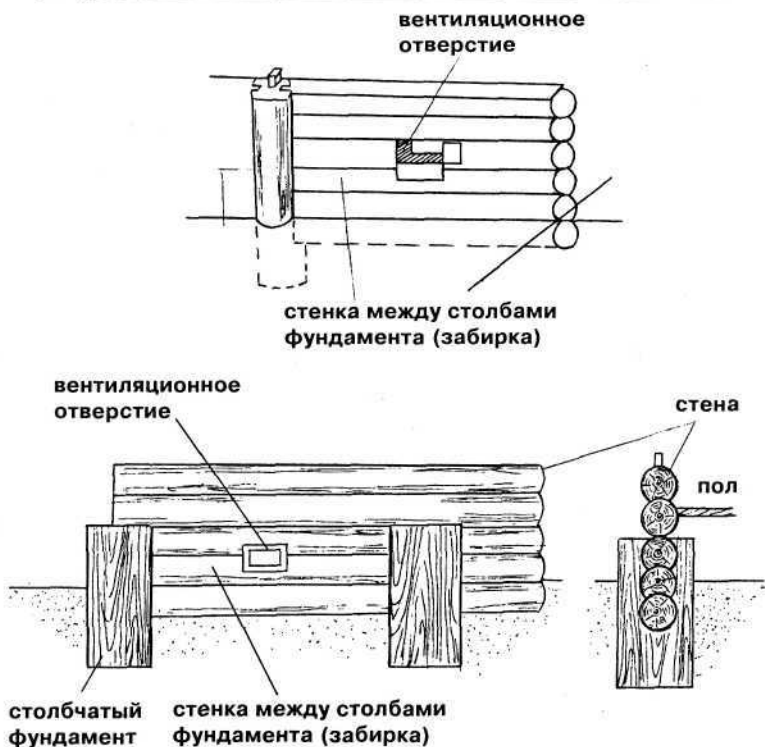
Устройство вентиляционных отверстий в фундаменте
